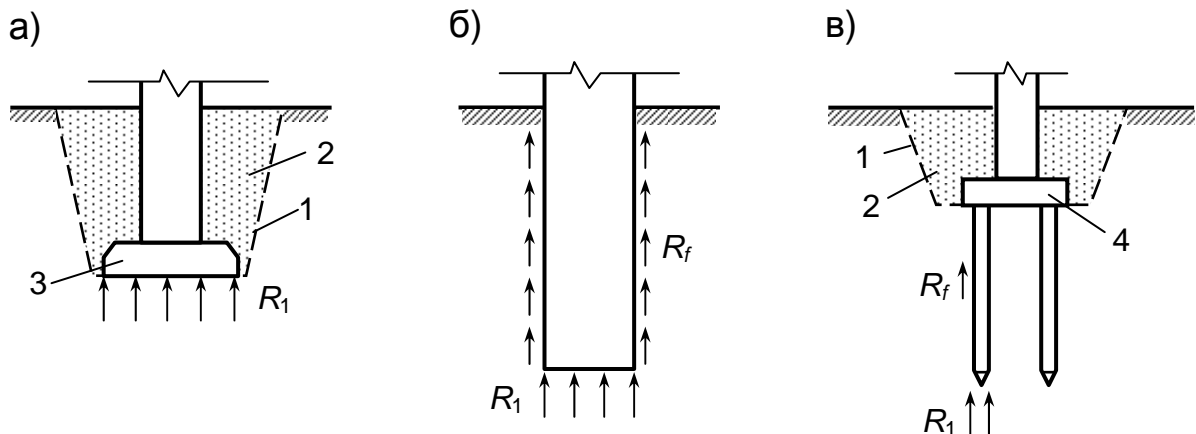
Схемы фундаментов: 1 – котлован; 2 – грунт обратной засыпки; 3 – фундамент; 4 – ростверк
